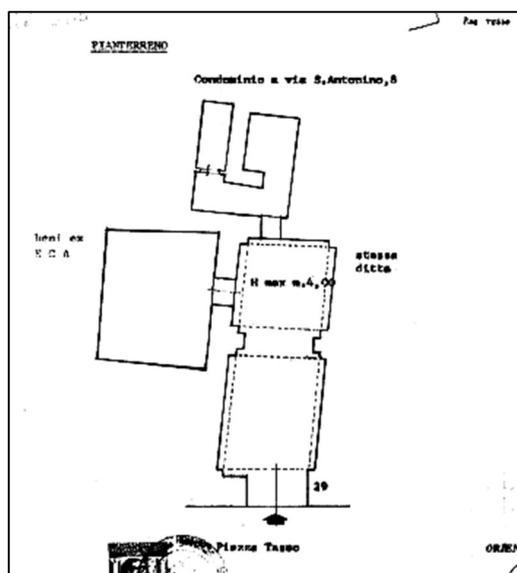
planimetria lotto 1 da planimetria catastale pregressa del 08/06/1979 (all. 4F)
